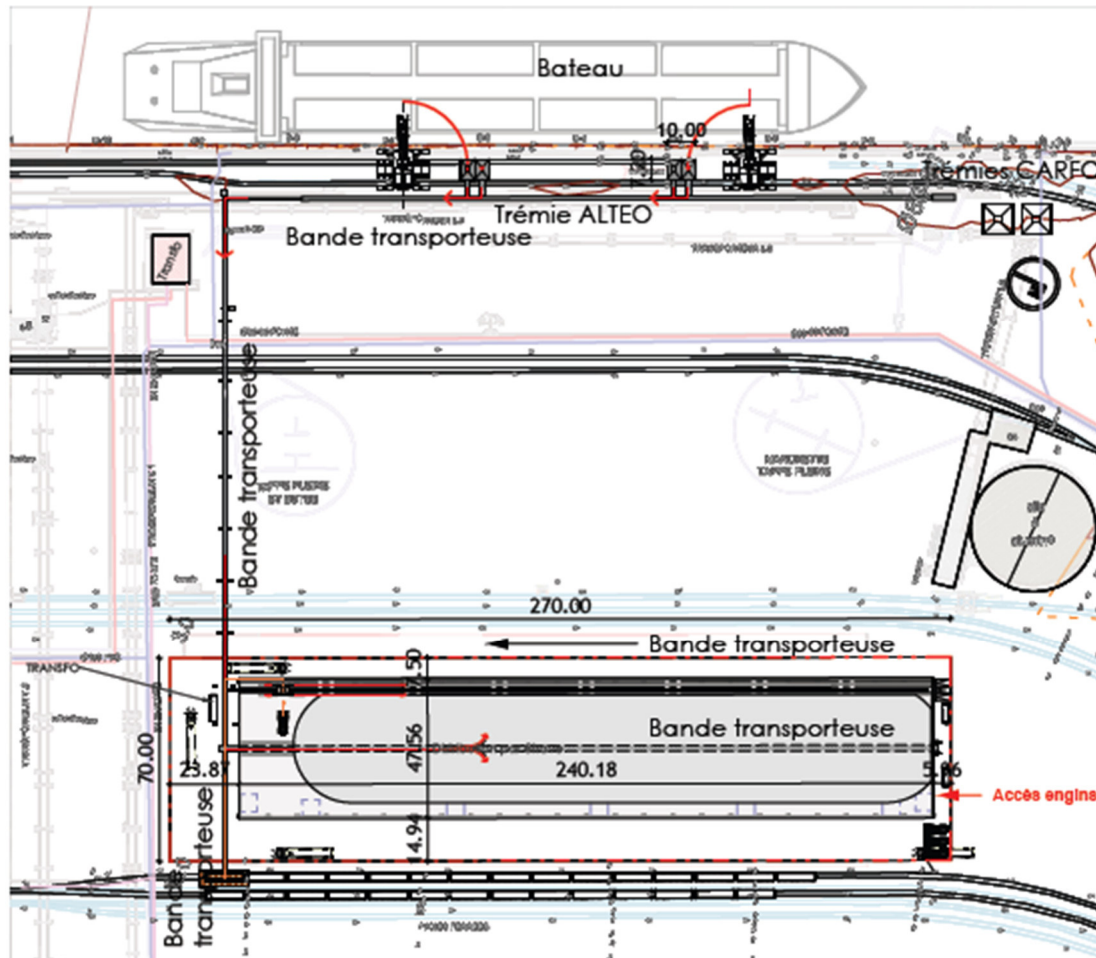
Plan de masse du projet d'aménagement (Source : Novelige)
